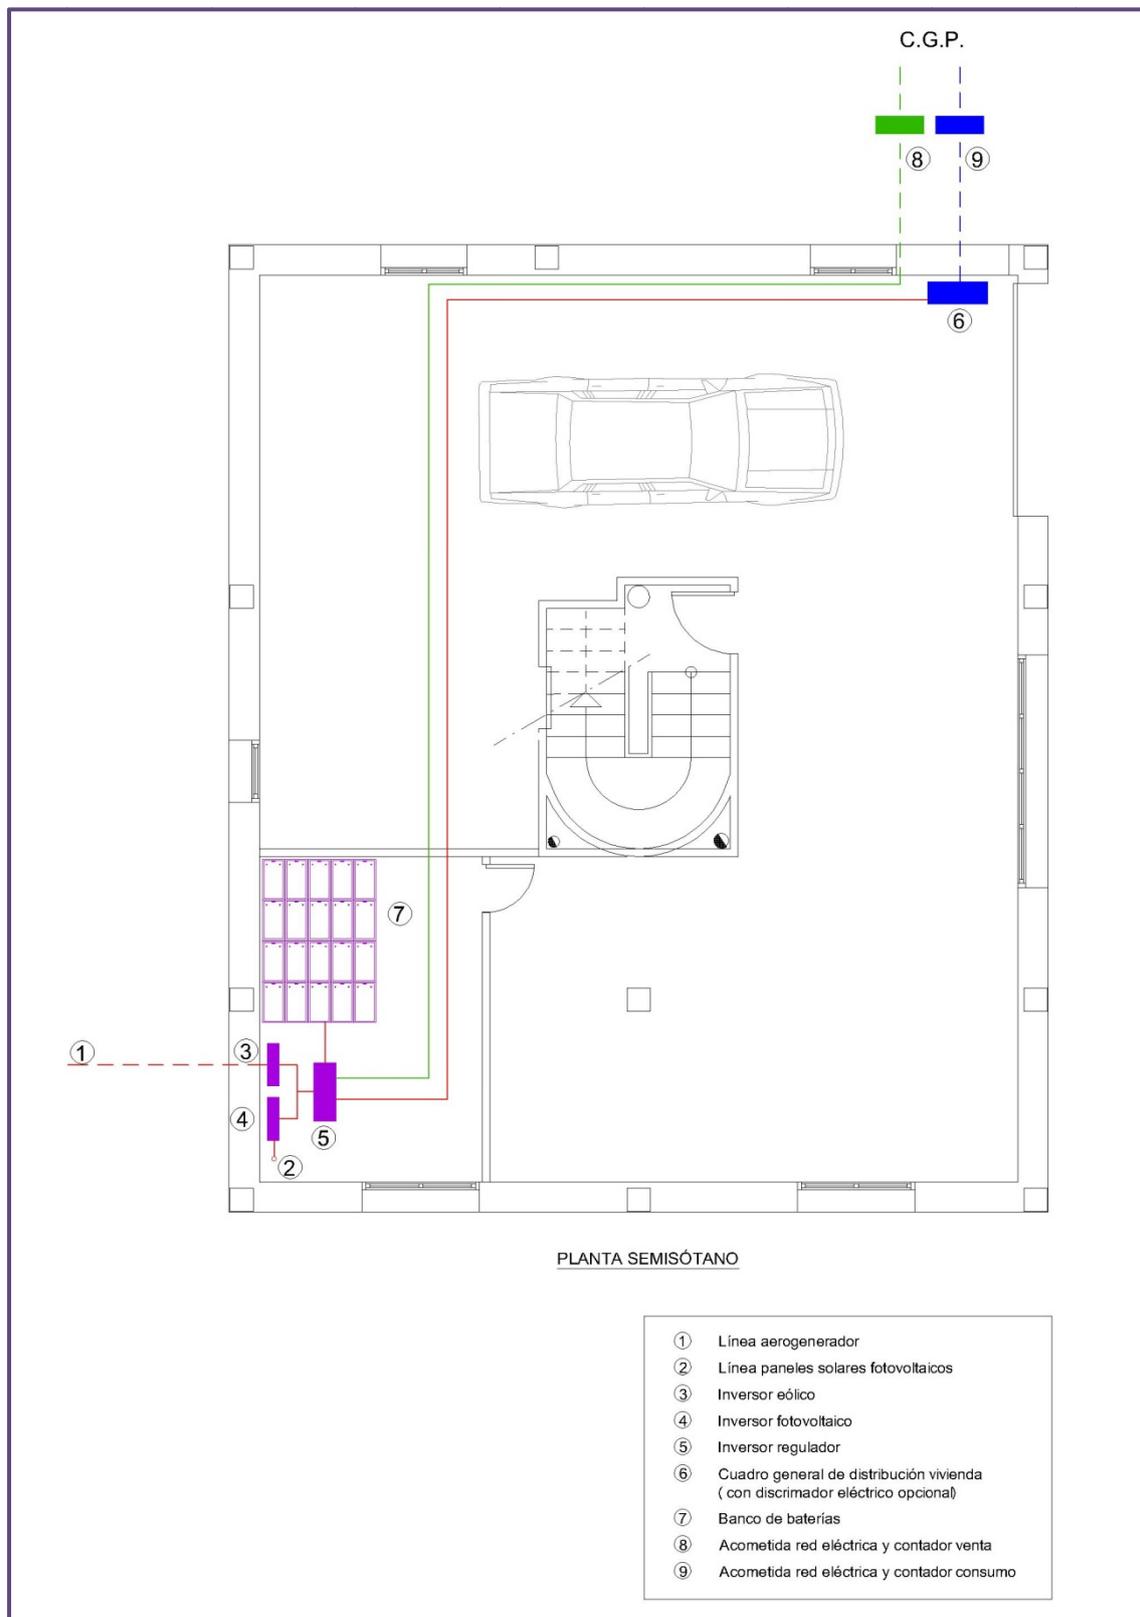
Plano planta semisótano - ubicación elementos interiores Kliux
